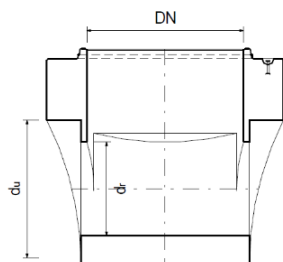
Anschluss mit Polyethylenrohre mit Gefälle J ≤ 500 ‰
